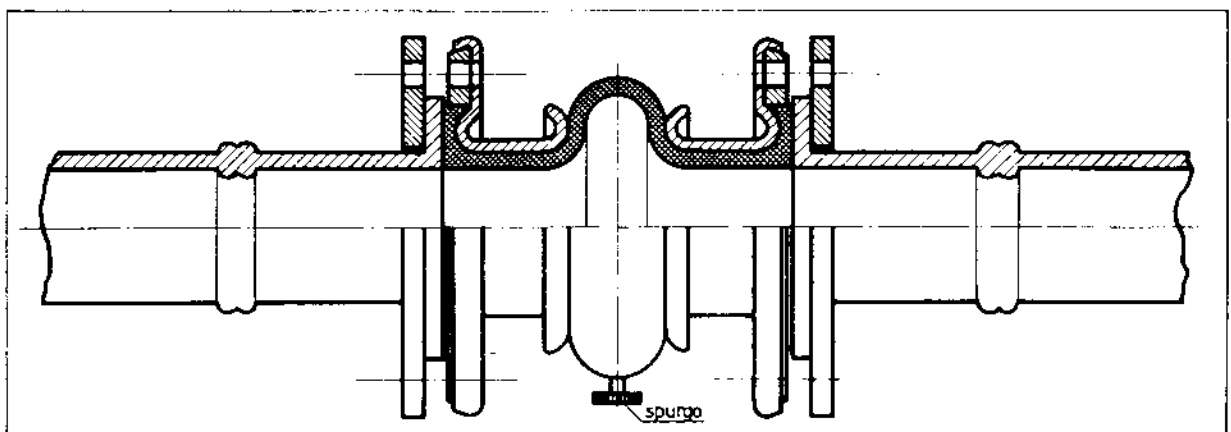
Giunto a soffietto in neoprene con collegamento alla condotta a mezzo flangia
